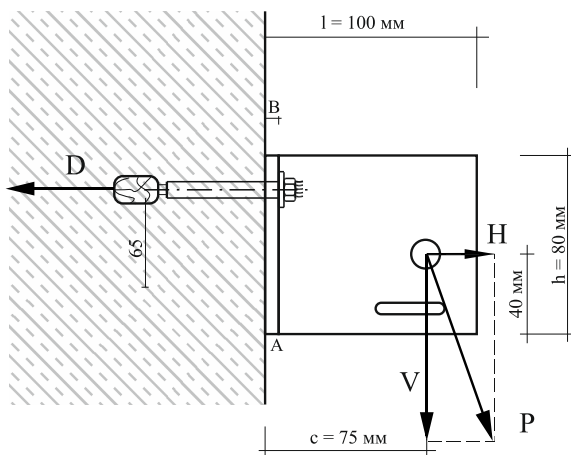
Расчетная схема опорной консоли навесного каркаса вентилируемого фасада
